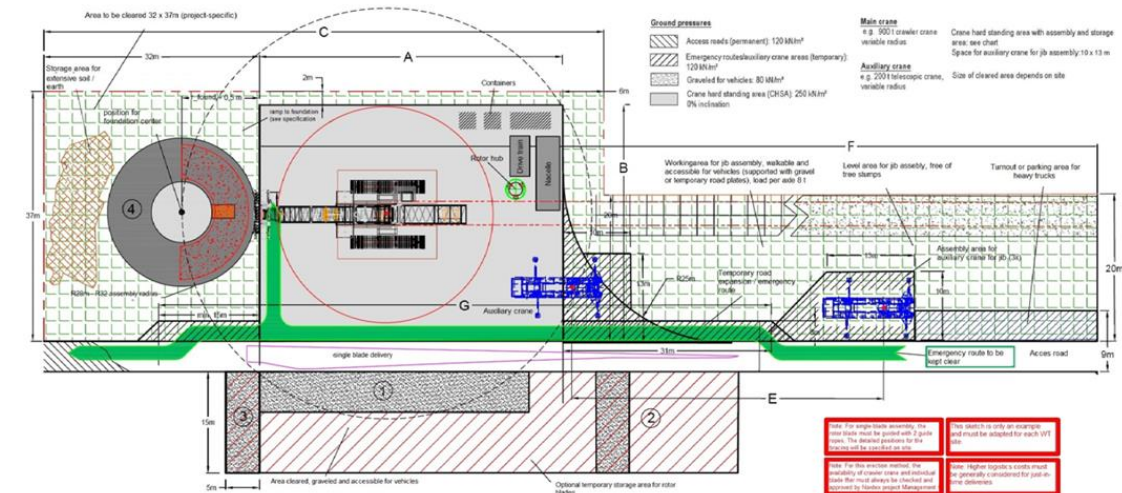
Plateforme de montage avec grue optimisée pour les zones sur les terrains ouverts (assemblage à une seule pale) pour les éoliennes d'une hauteur de moyeu jusqu'à 170m
